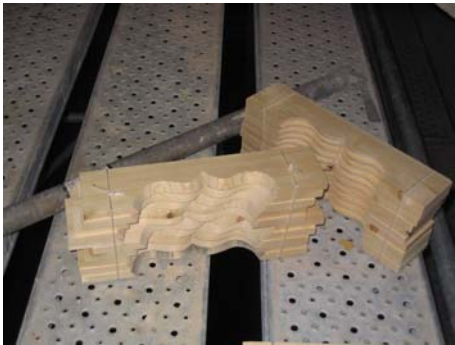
Piezas prefabricadas, en este caso se trata de las correspondientes a las cintas colocadas con una cierta separación entre sí para la posterior colocación de los saetinos.
